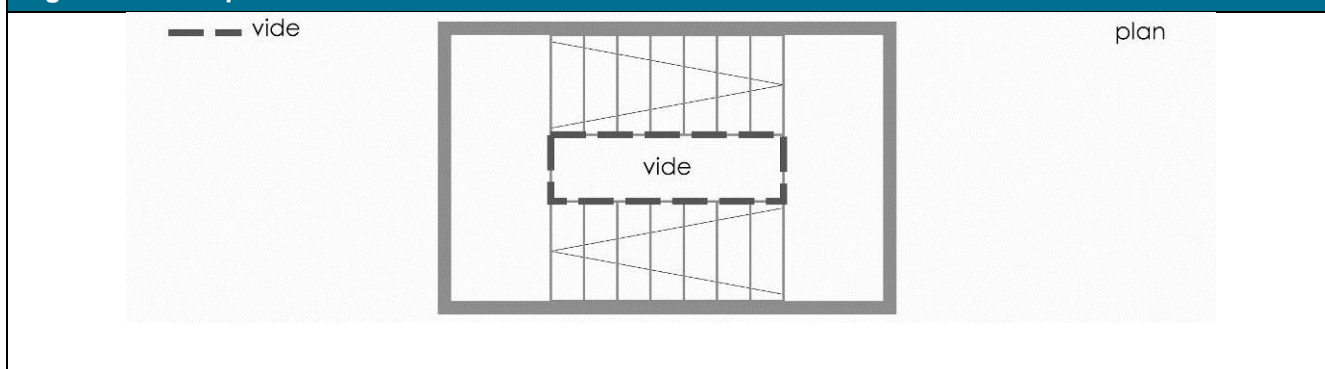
Surface plancher de l'unité à partir de 2,10m de hauteur
